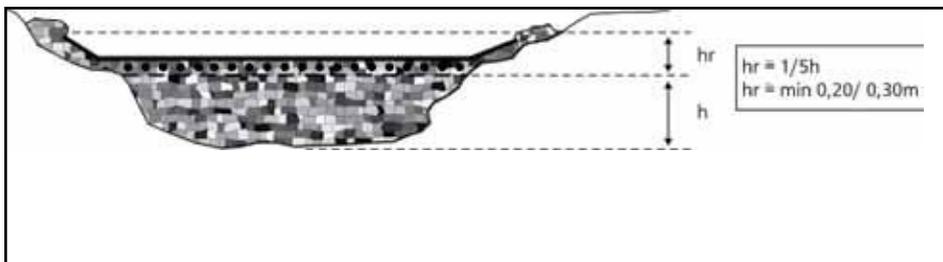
Vista Longitudinal de uma Barragem de Pedra
